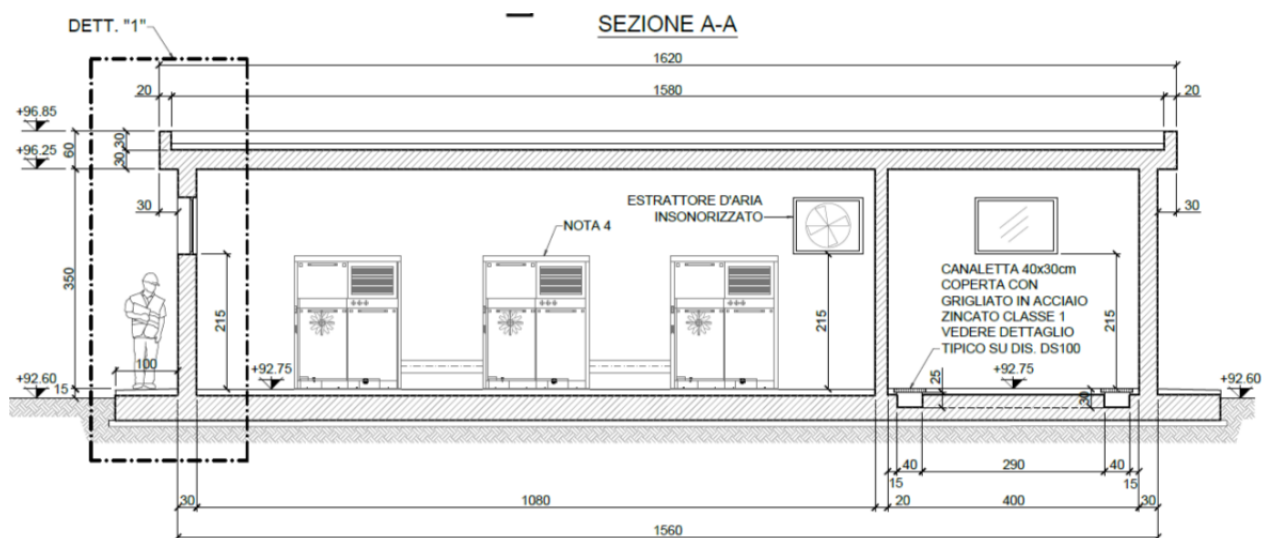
LOCALE SOFFIANTI - SEZIONE A-A
